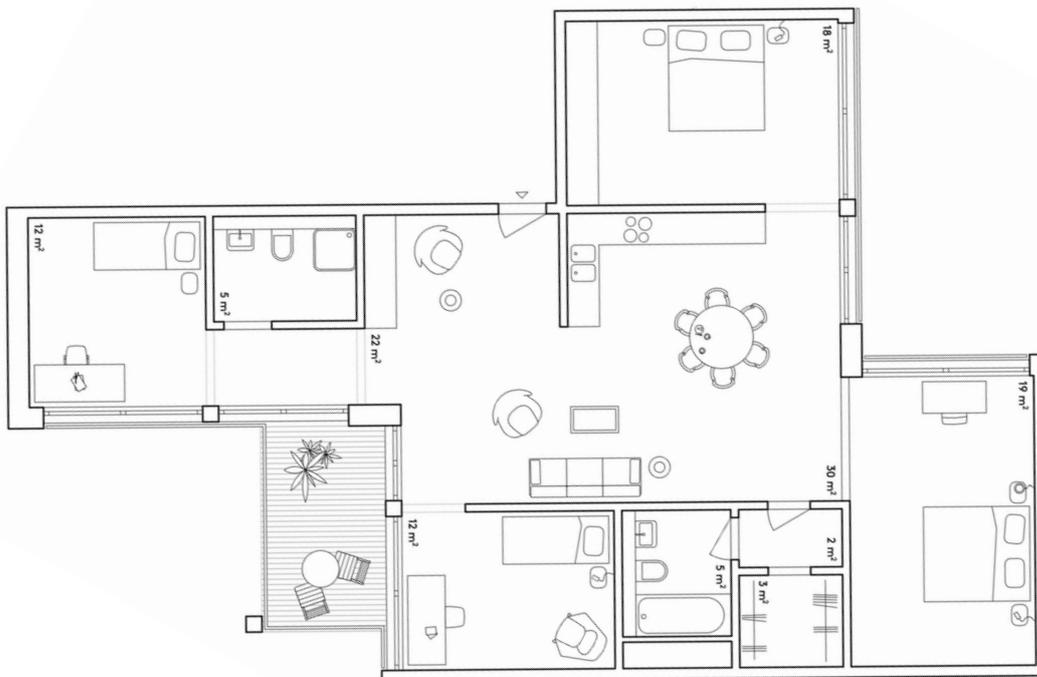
Wohnungsgrundriss 5.5 Zimmer - Whg.
